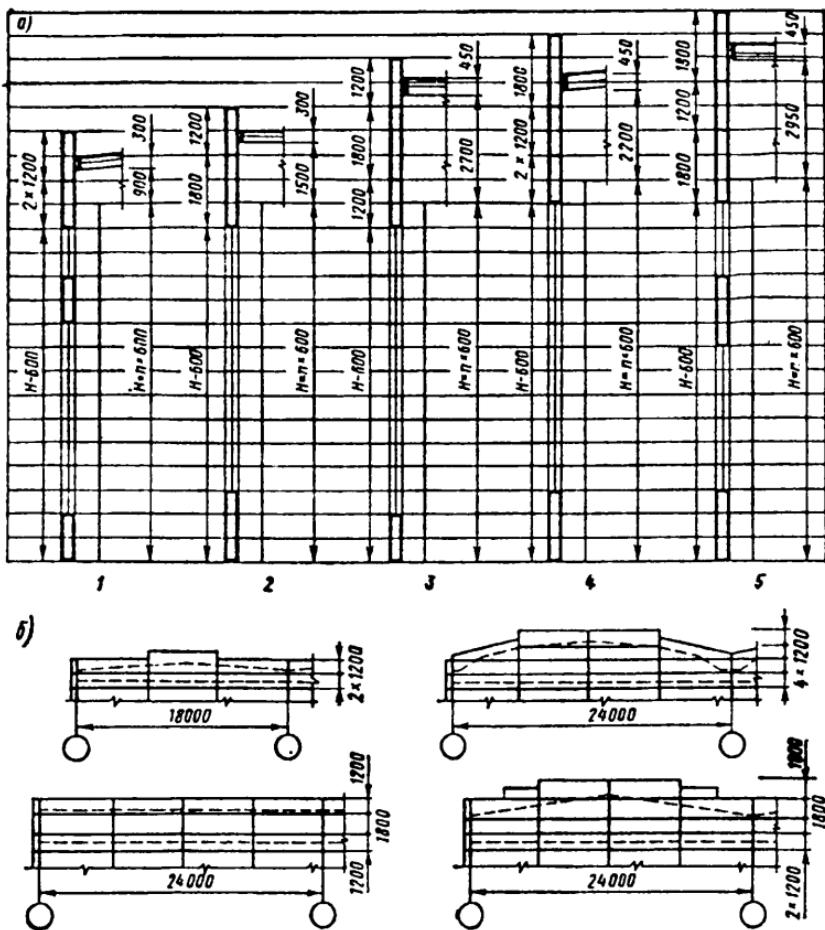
Схемы раскладки панелей в стенах одноэтажных зданий:
